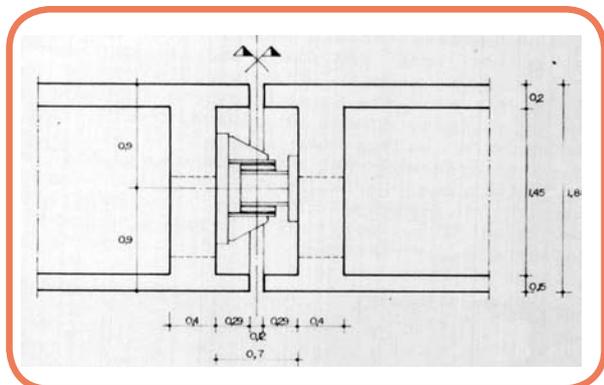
Detalhe da articulação central prevista no projeto original alterado pela introdução da viga metálica central.
